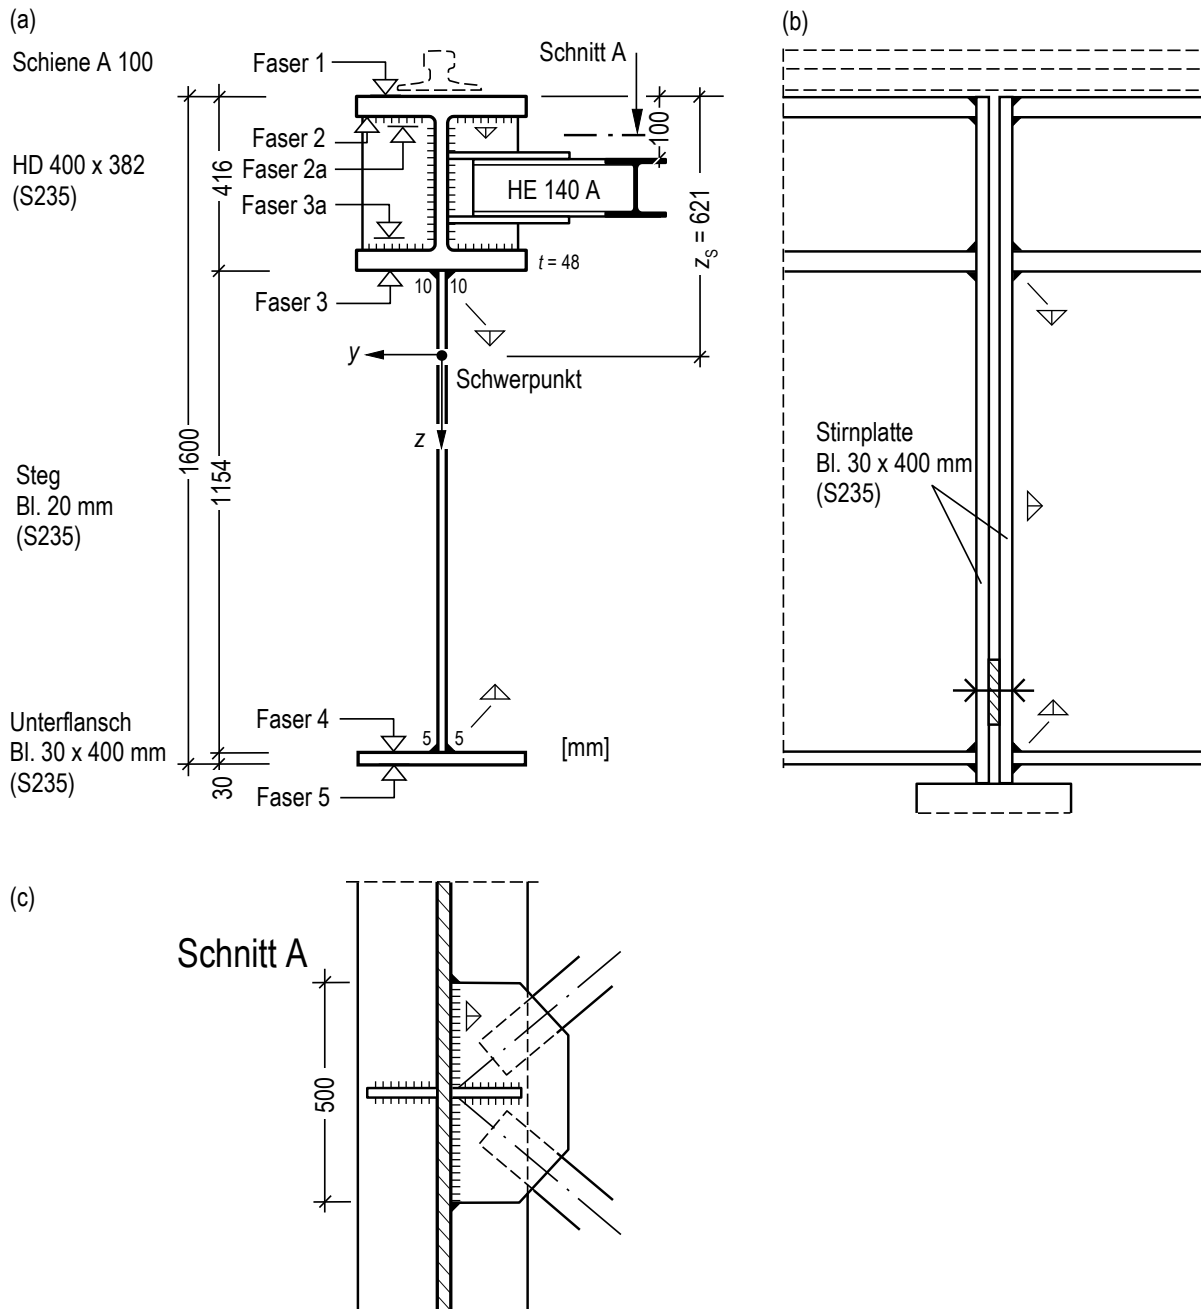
Querschnitt und Auflagerdetail des Kranbahnträgers: (a) Querschnitt, (b) Längsansicht am Auflager, (c) Schnitt A, Knotenblechanschluss
